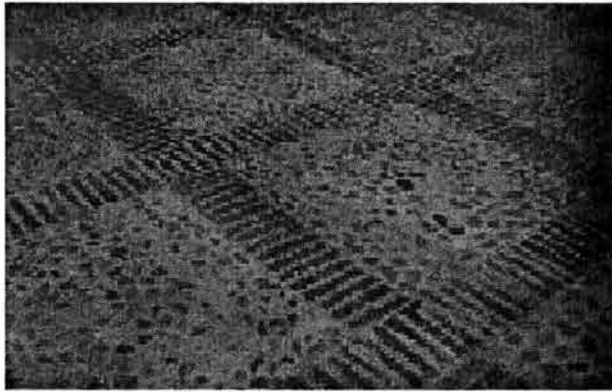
Pavimento de piedra con lajas de ladrillo.
